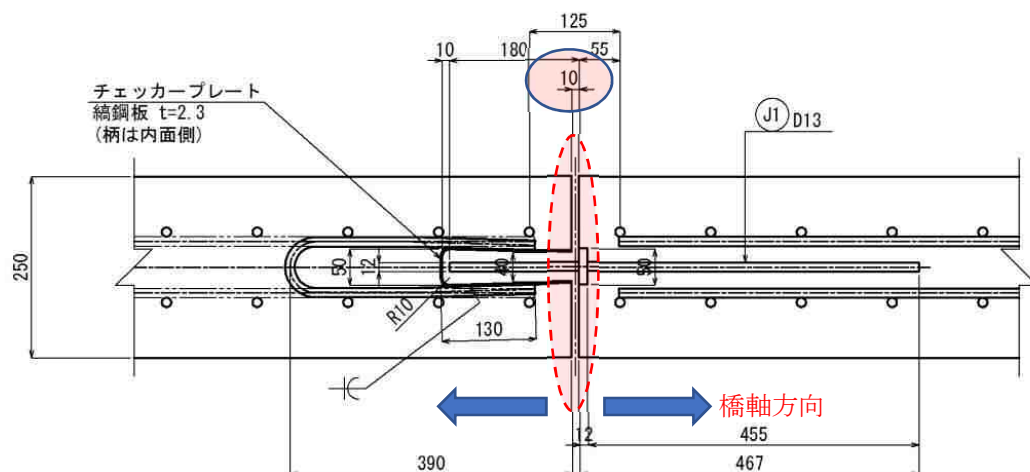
プレキャスト壁高欄同士の間隔（平面配置）
